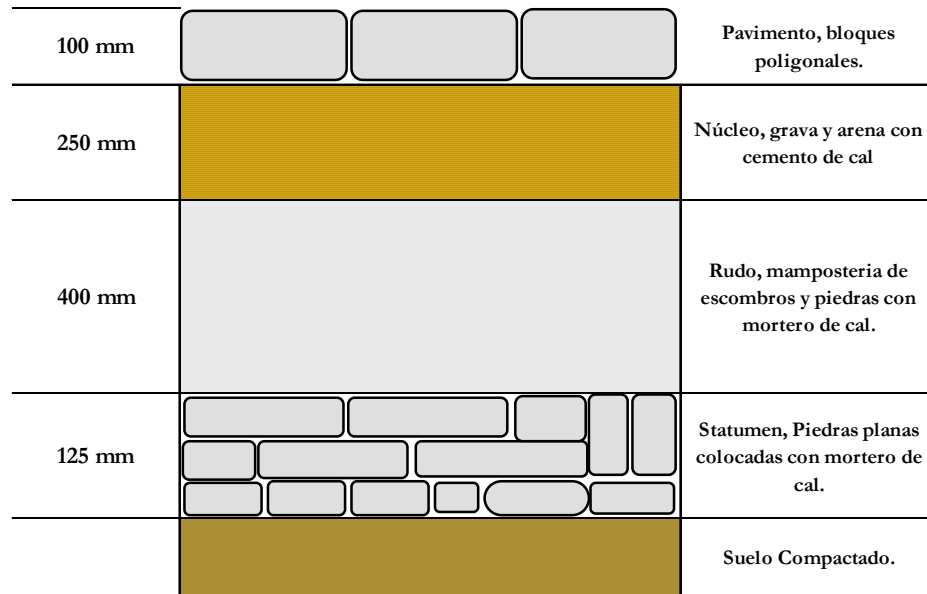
Pavimento Estándar Romano. Fuente: (Mendoza-Sánchez et al. 2023)
